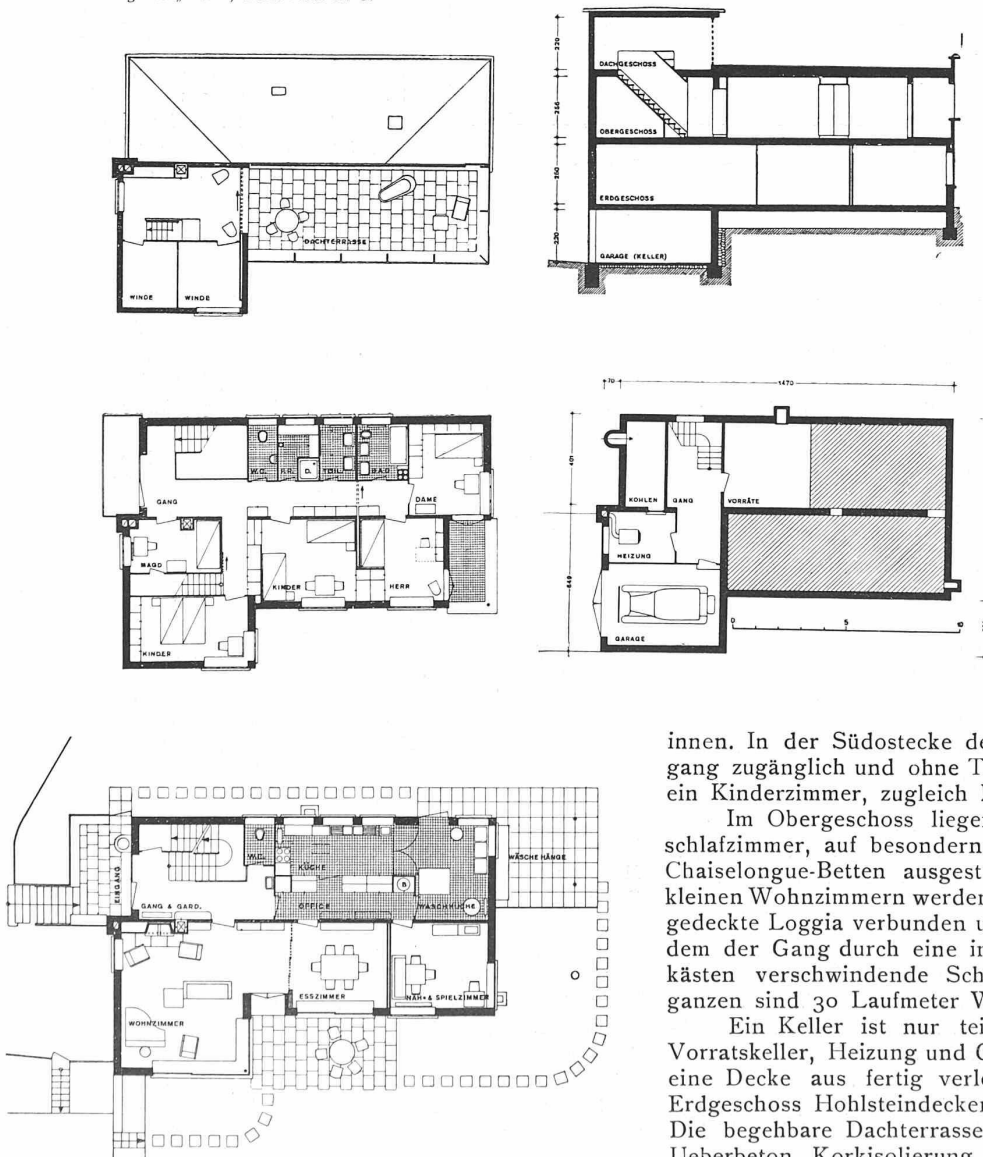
bis 17. Grundrisse und Längsschnitt. — Masstab 1 : 300.
